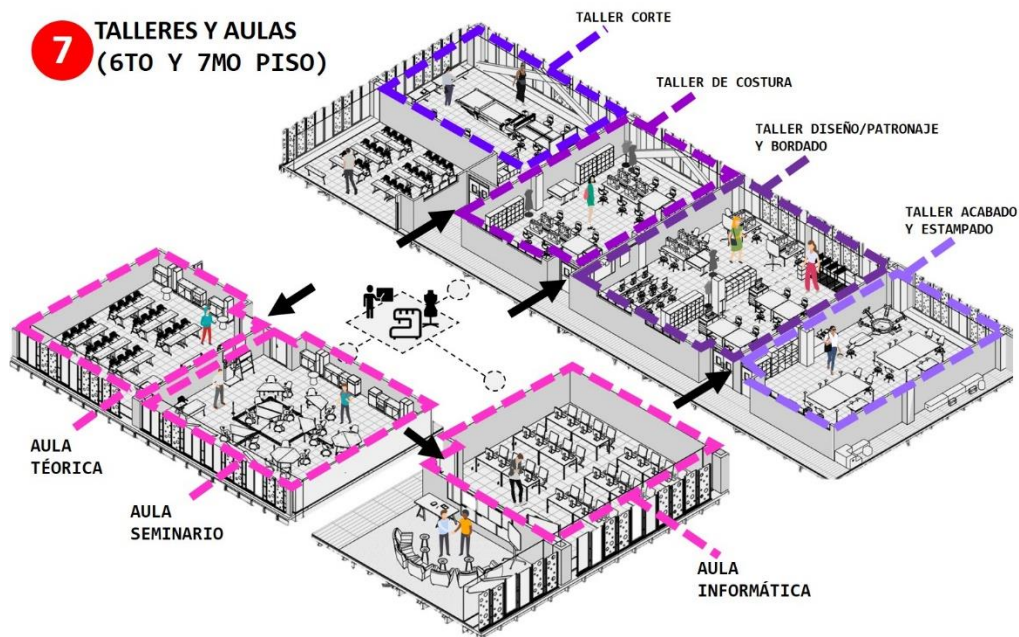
Vista de axonometría de las aulas y talleres ubicados en el sexto y séptimo piso.
